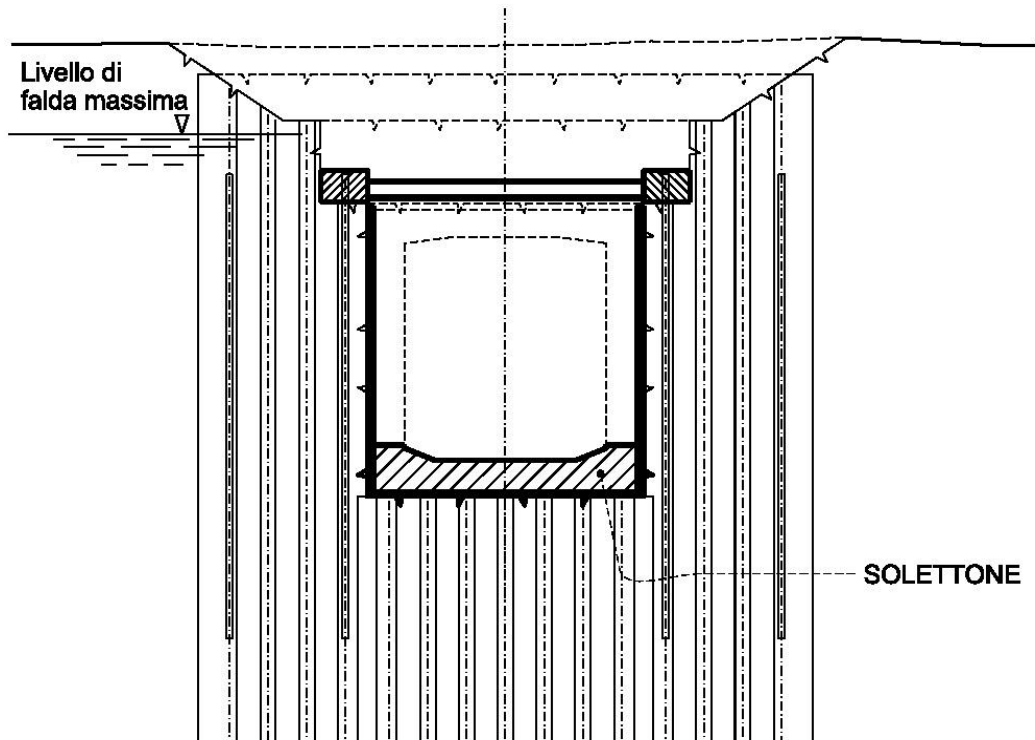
Aufbau der Bodenplatte aus Beton für das endgültige Gewerk; Entfernung der temporären Streben, die sich mit dem Gewerk überschneiden.
